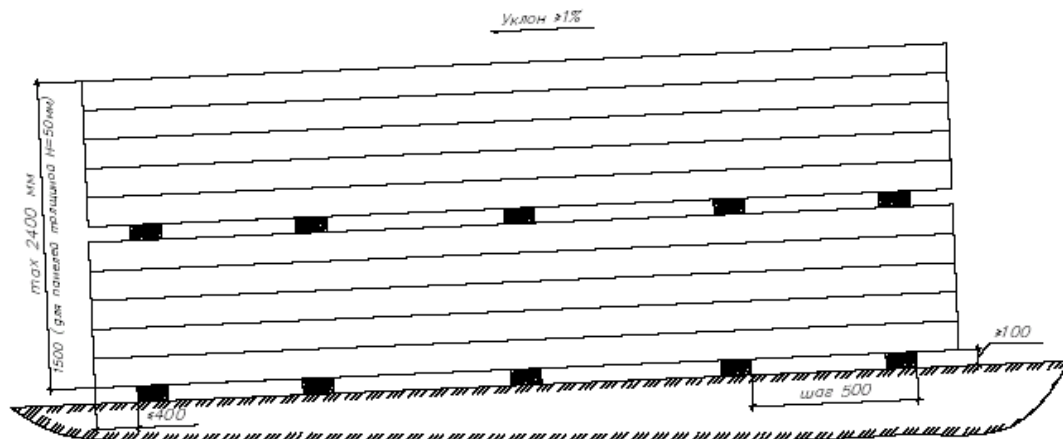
Схема складирования пакетов стеновых и кровельных панелей.
